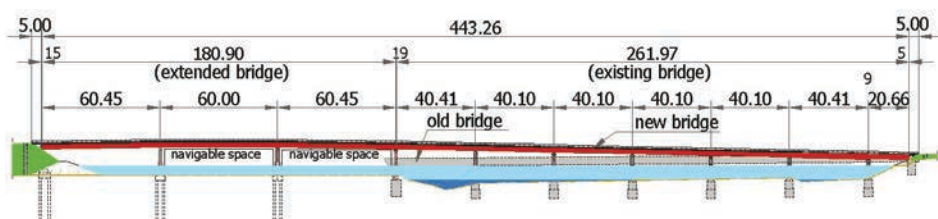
Elevația podului peste râul Olt la Stoienesti pe DN 6 București-Craiova
